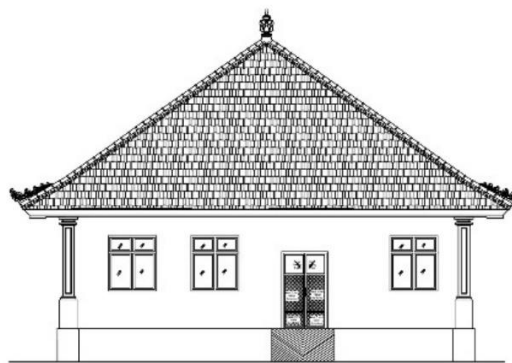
Denah Gedung Gizi RS Gema Santi Nusa Penida
